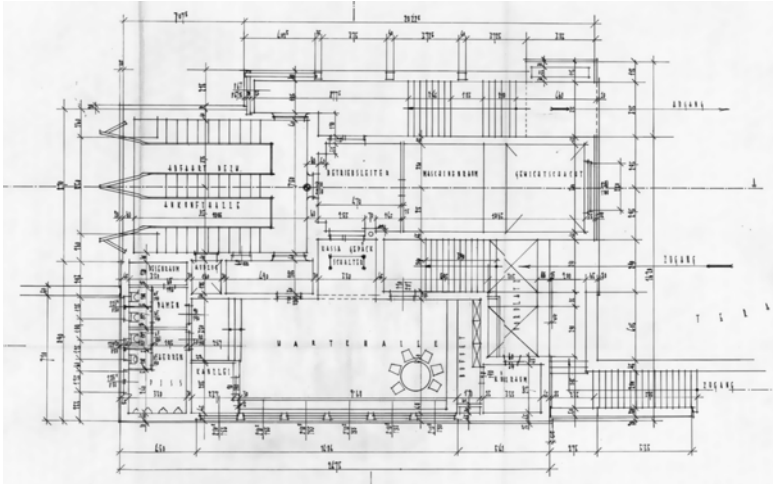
Franz Baumann, Talstation der Nordkettenbahnen, Innsbruck, Grundriss
